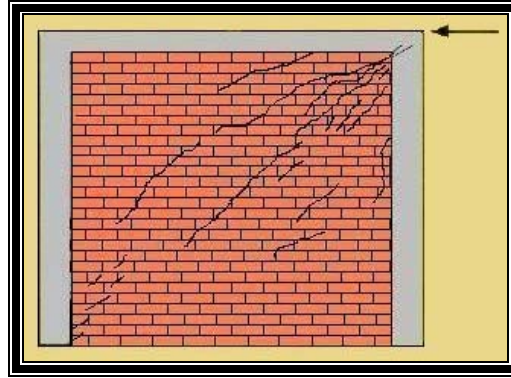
Ensaye en voladizo de un muro de mampostería confinada
